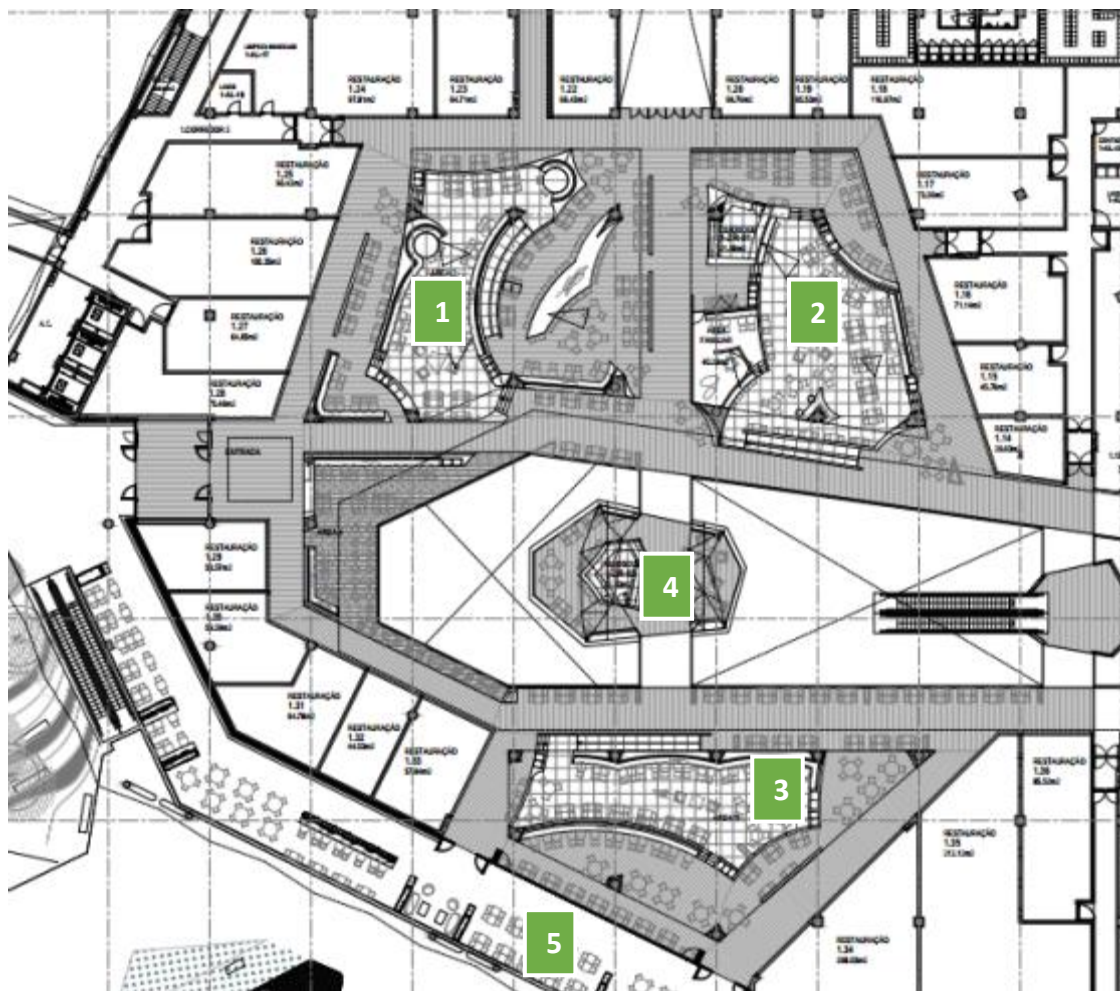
Planta Geral de Arquitetura do FoodCourt – Piso 1 [Fonte: Ref. Desenho PE-FC-01; Autor: Atelier NiNi Andrade Silva]
